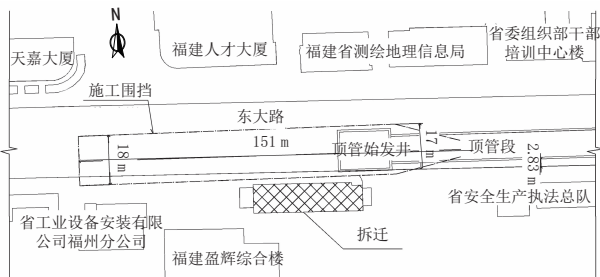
省立医院站—东门站区间渡线段顶管施工占地平面图
